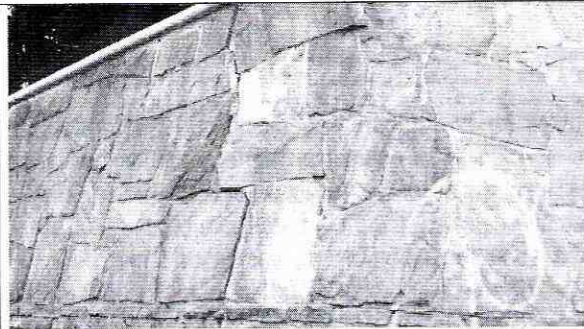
Fisuras que siguen la línea de la pega.
